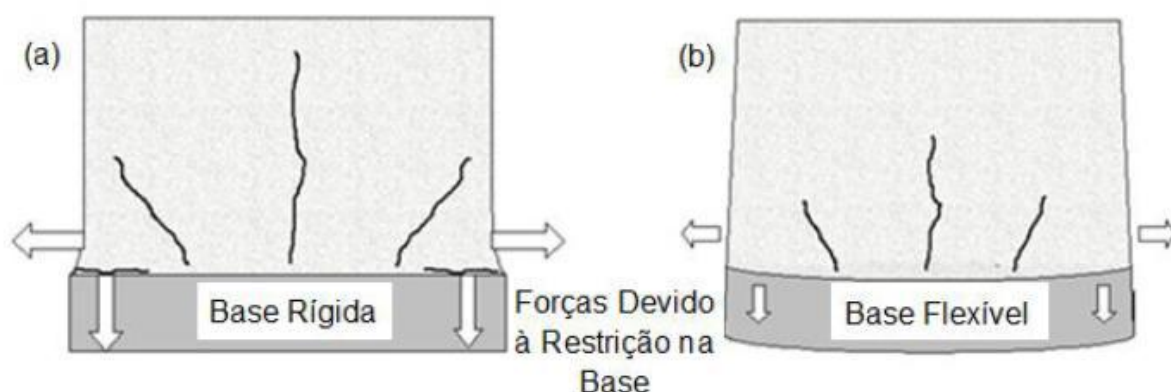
Padrão de fendilhação: a) sapata rígida; b) sapata flexível [10]
